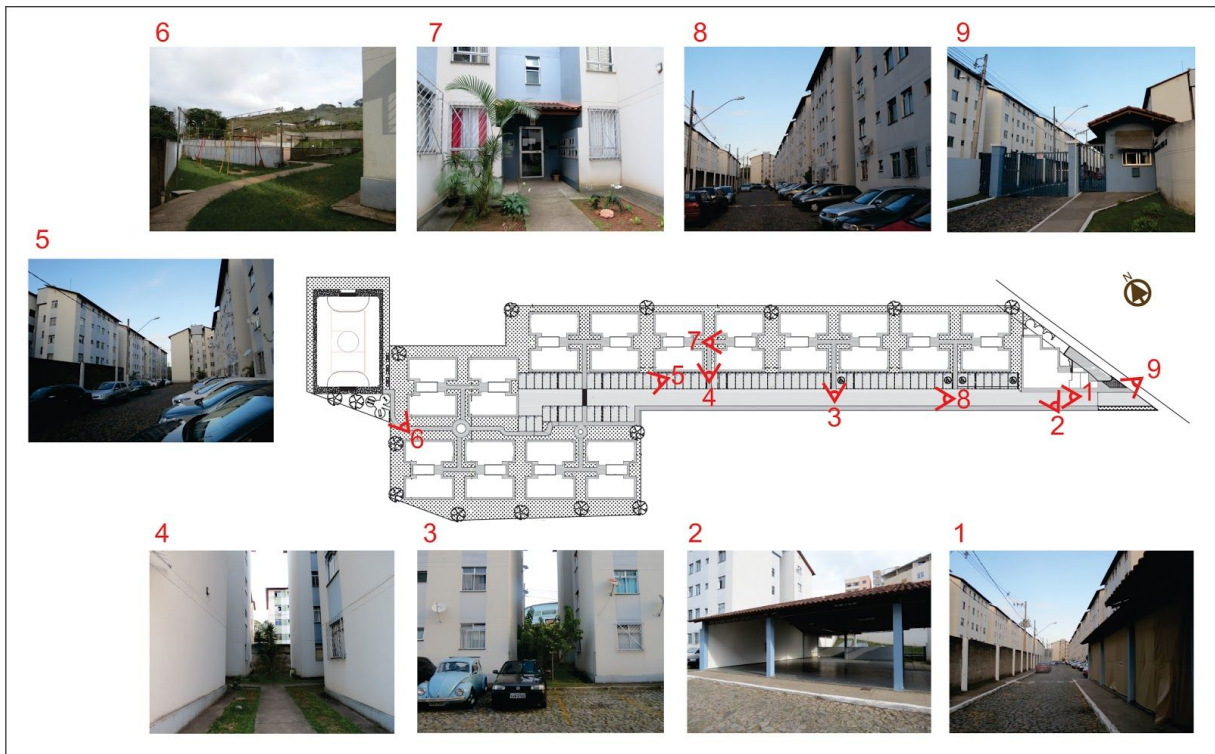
implantação e fotos do Vivendas da Serra III (arquivo pessoal).
